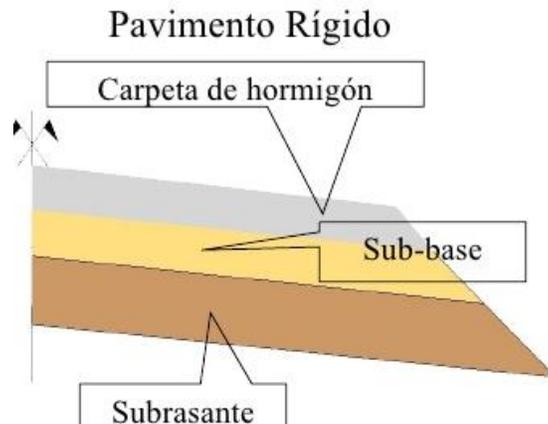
Pavimento Áreas de tránsito de camiones de losas de hormigón
